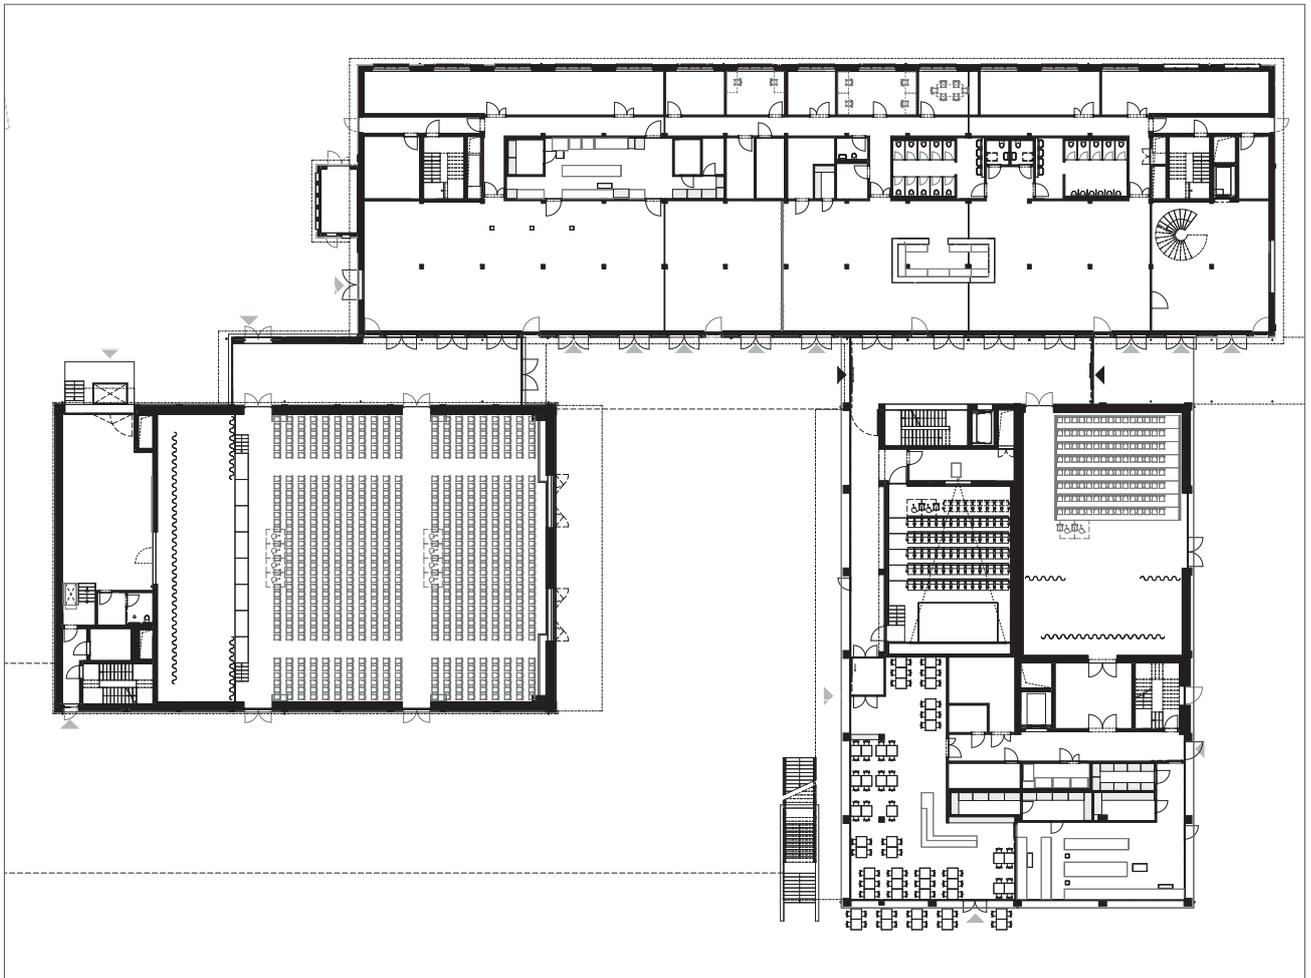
Grundrissplan; links: Grosse Saal, Mitte: Zeughaus K2 mit Foyer, rechts: Regal mit Kino, kleiner Bühne und Gastronomie
